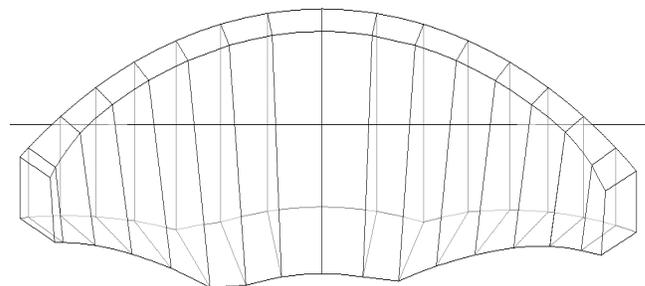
Bloques con corte del terreno (Fuente: Elaboración propia).
